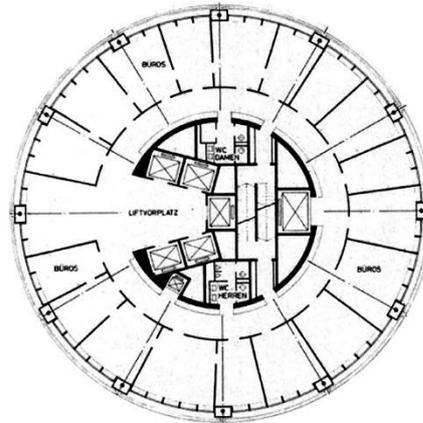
Basel, BIZ-Turm und Grundriss
